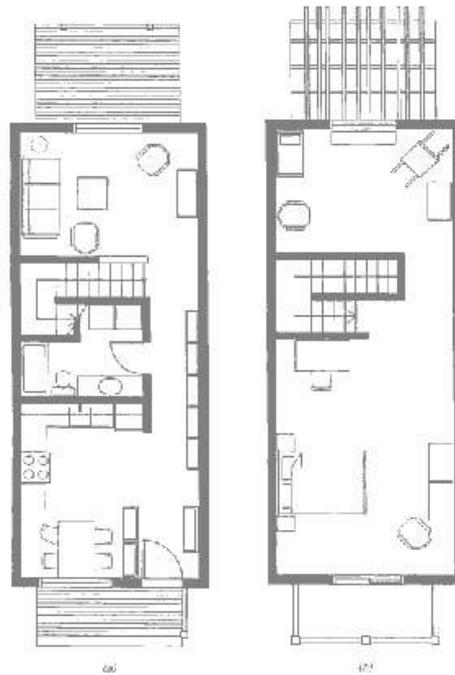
planta do primeiro e segundo pavimentos da Grow Home
